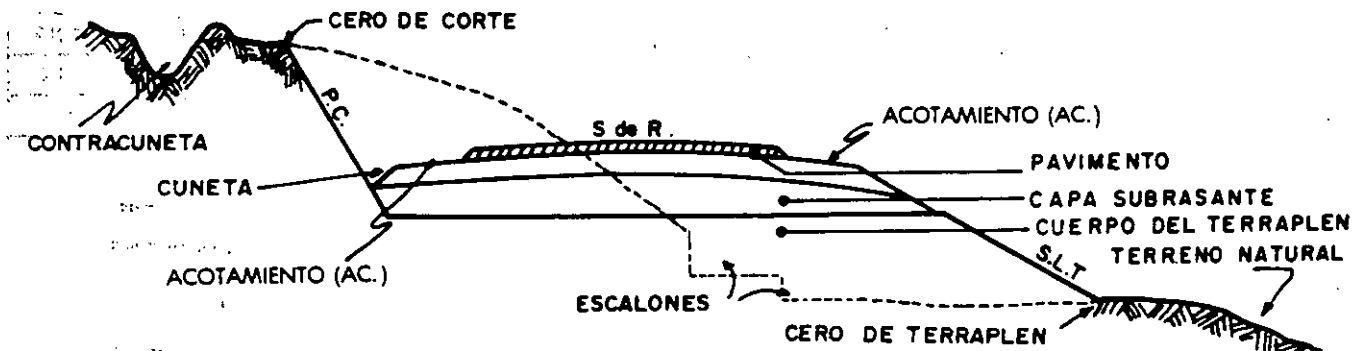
Sección transversal típica mixta o en balcón, para caminos de dos carriles.
